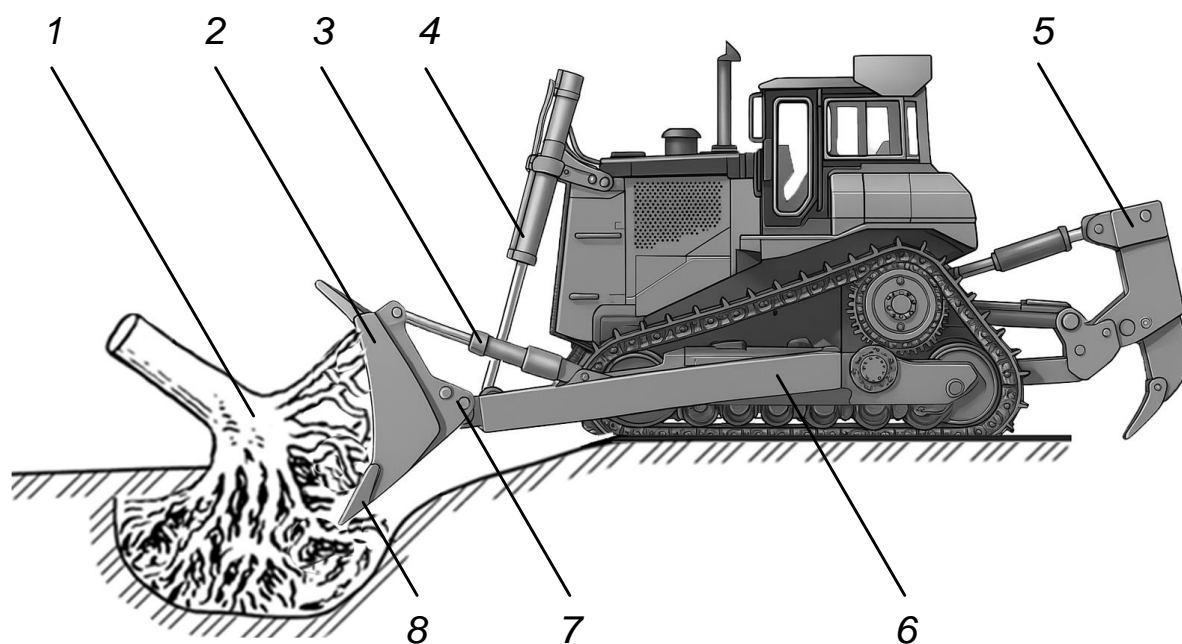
Конструктивно-технологічна схема корчувача-збирача: 1 – пень; 2 – полиця; 3 і 4 – гідроциліндри; 5 – гак; 6 – рама; 7 – балка; 8 – клики
